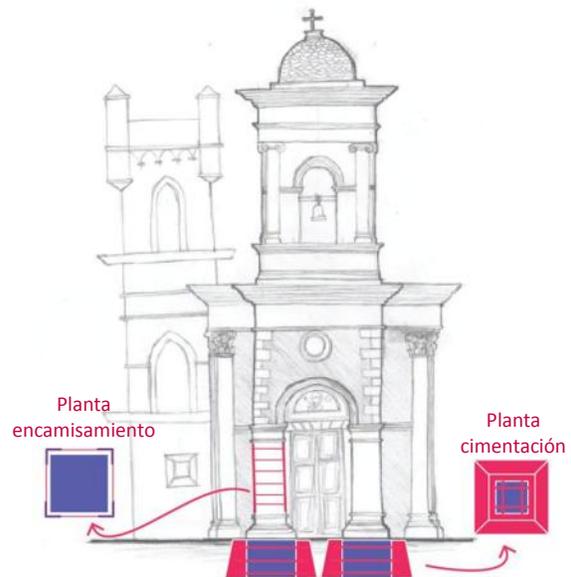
Propuesta de refuerzo de cimentación y de cinchos para la columna - elaborado por el autor
